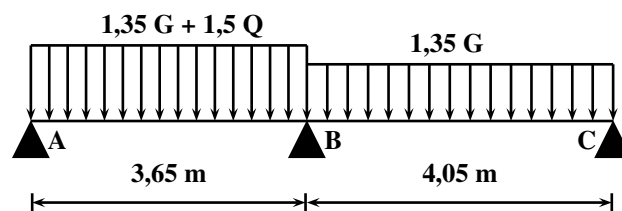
Poutrelle type 1 - cas 3 (ELU)
